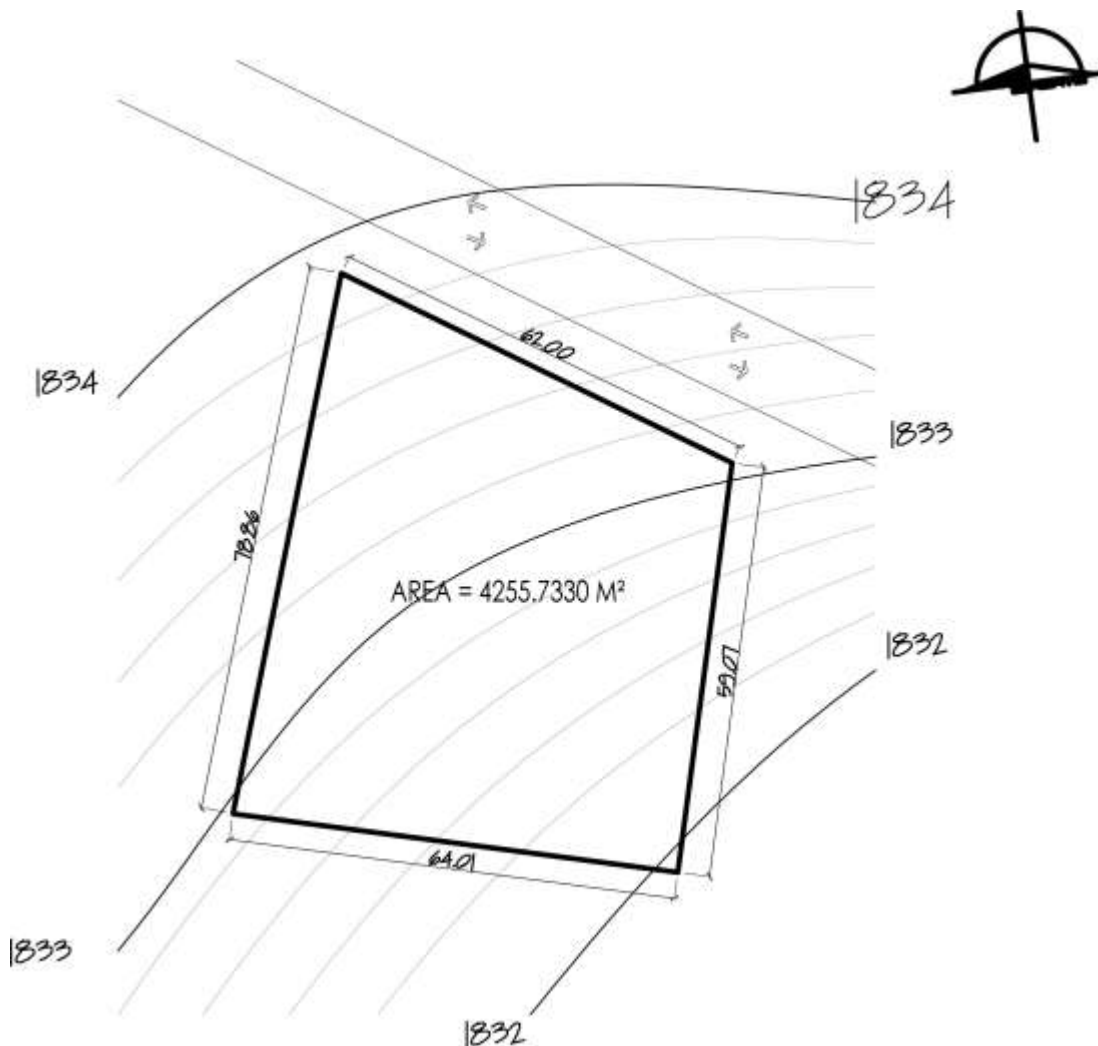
PLANO DE UBICACIÓN DEL TERRENO A INTERVENIR.
